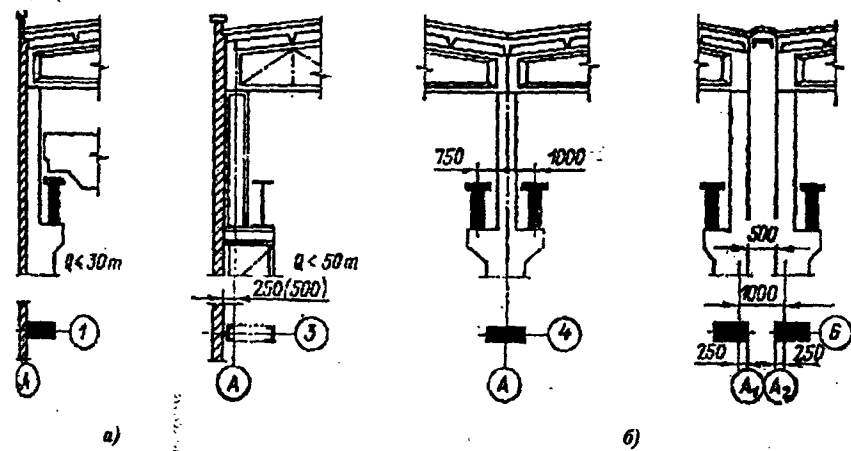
Примыкание ферм покрытия к стен к колоннам:
